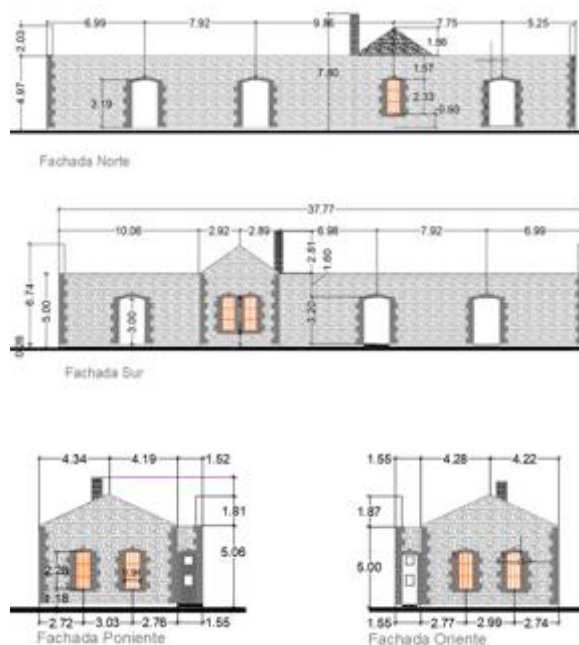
Fachadas del inmueble, norte, sur, este y oeste, - Planos. Arq. David García Villegas Febrero 2018
